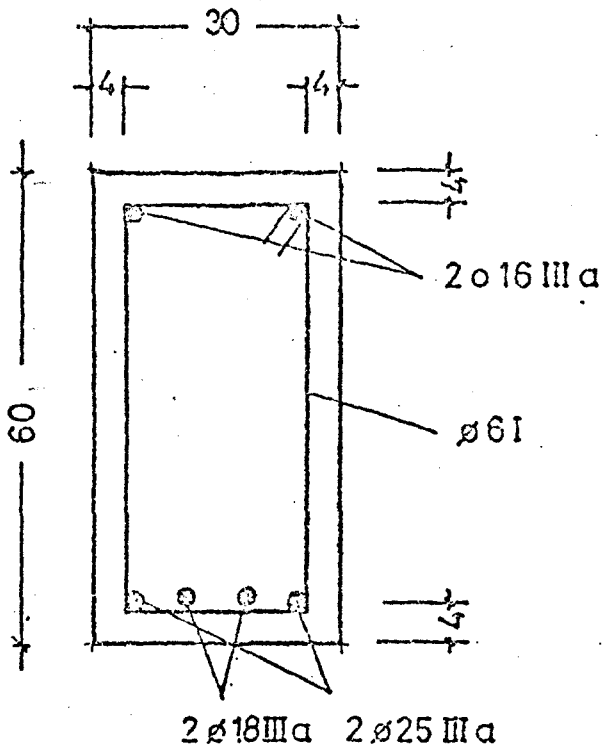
Abmessungen und Belastungen der untersuchten Stahlbetonbalken
